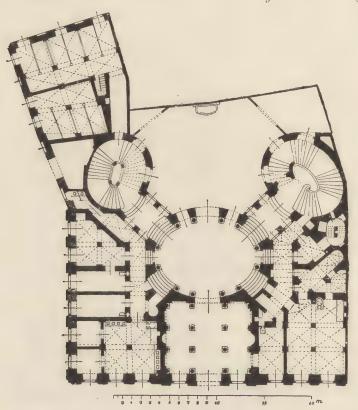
Palais Schönburg zu Dresden. Grundriss des Erdgeschosses.
